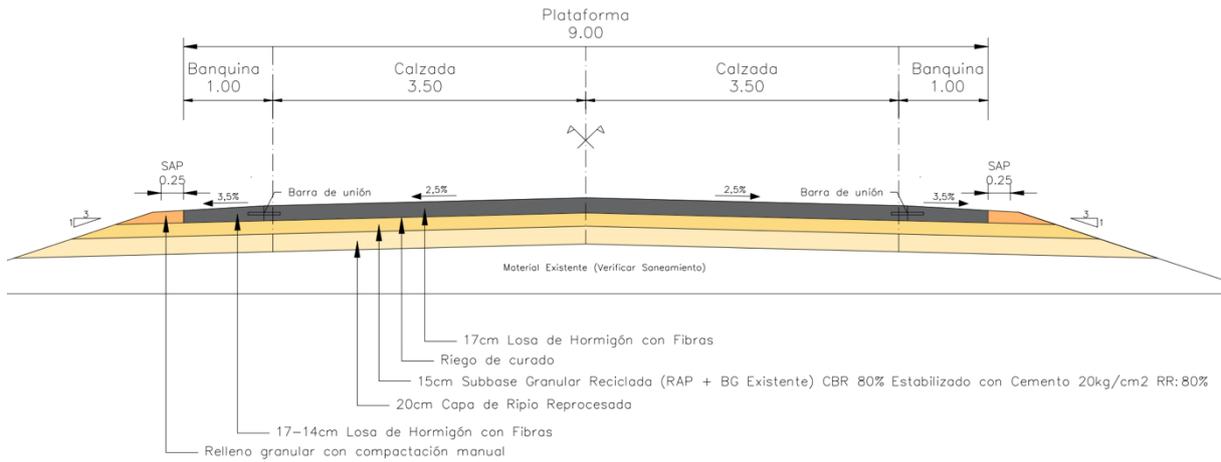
Sección transversal tipo de pavimento rígido convencional
